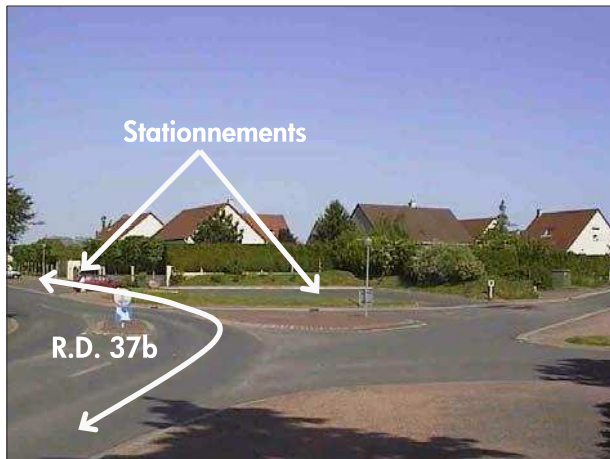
carrefour aménagé sur la R.D. n°37b, à l'Est de l'école.
